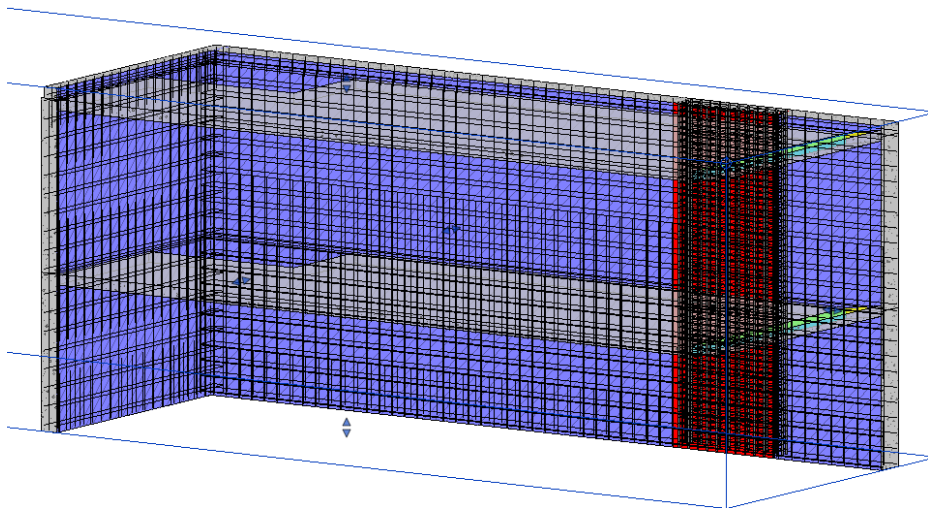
Modelado del acero de refuerzo de la columna C1.
